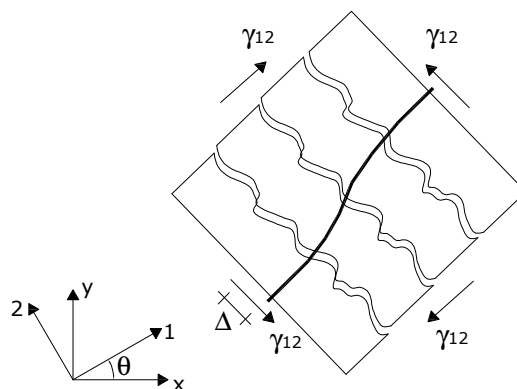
Efeito de pino da armadura nas faces das fissuras (He & Kwan 2001)
